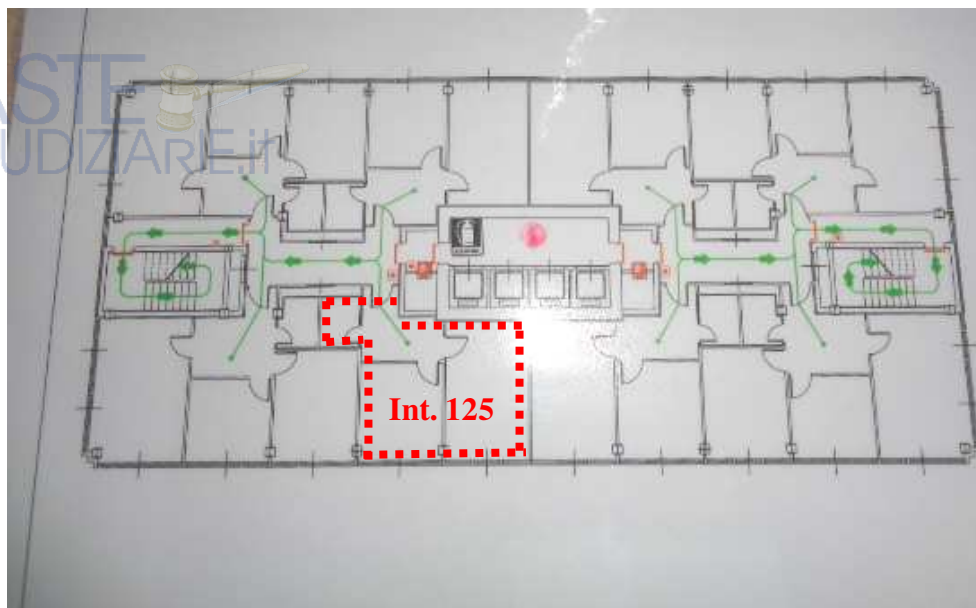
Schema 16° piano e individuazione dell'immobile d'interesse
